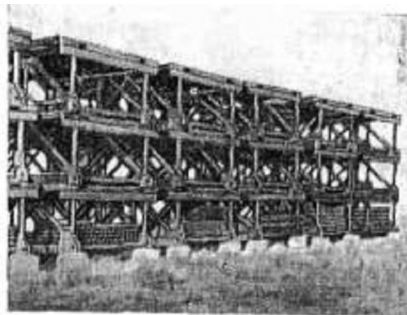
Укладка конструкций моста в штабеля № 1-10
